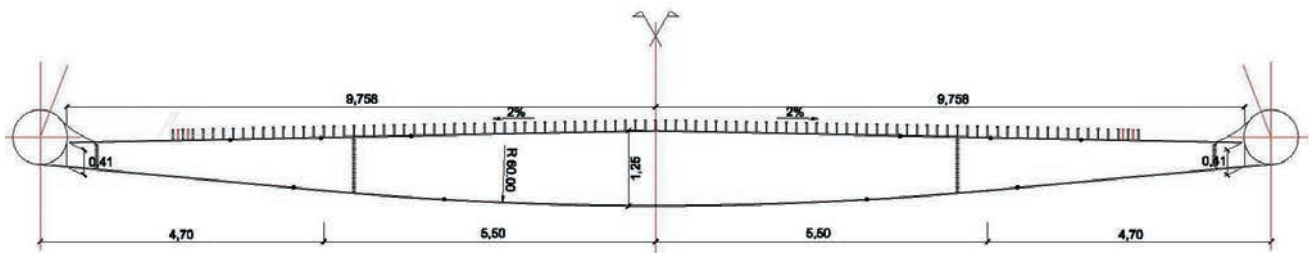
Detalle de una viga trasversal tipo del tablero situada cada 5 m
